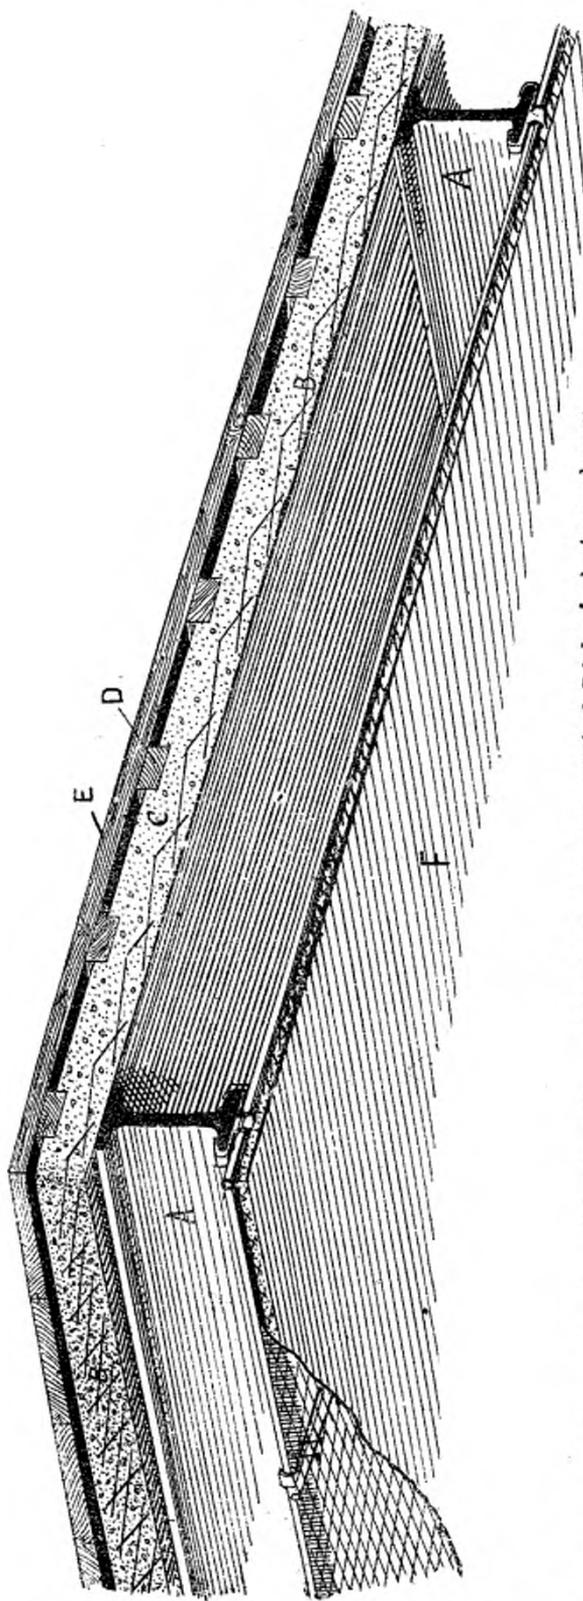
Plancher système I. — A, A, Poutrelles en acier ; B, B, Armature en Métal Déployé placée sur bourrelets supérieurs des poutrelles ; C, Dallage monolithique en béton ; D, tasseaux légers supportant le plancher en bois E ; F, Plafond suspendu aux bourrelets inférieurs des poutrelles
